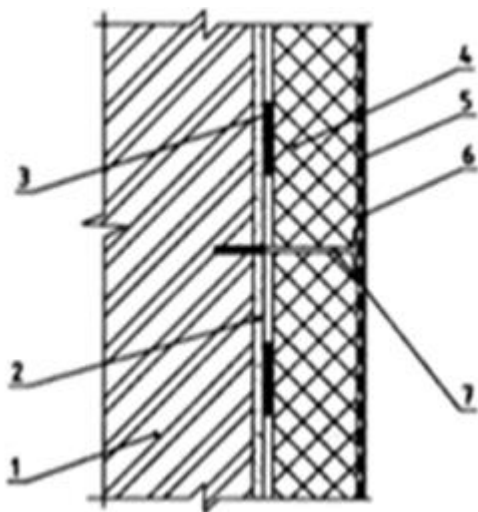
Конструктивна схема збірної системи мокрого утеплення фасаду. Де: 1- несуча стіна; 2 штукатурний шар; 3-клейовий шар; 4-теплоізоляція; 5-захисний шар армований скло сіткою; 6- опоряджувальне покриття; 7- елементи механічного кріплення теплоізоляції.
